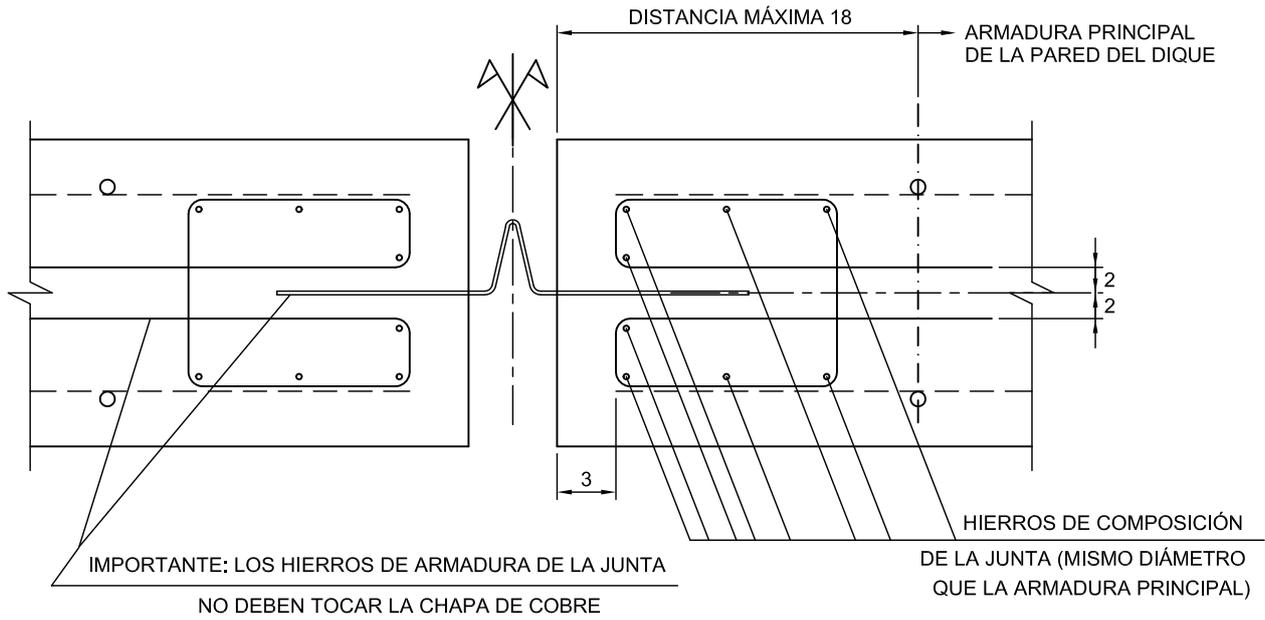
Detalle de la Armadura en la Junta
